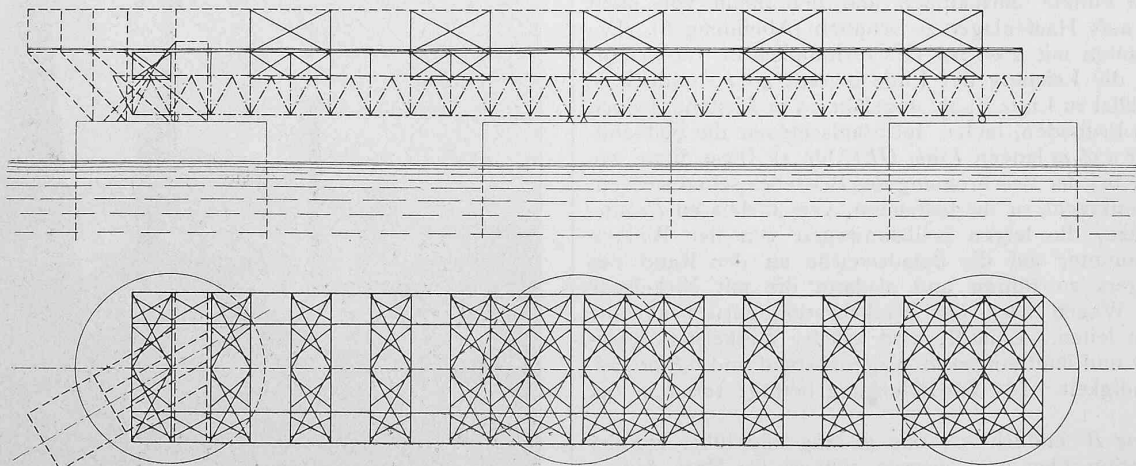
Grundriss und Aufriss der eisernen Verladebrücke. — Masstab 1:500.
